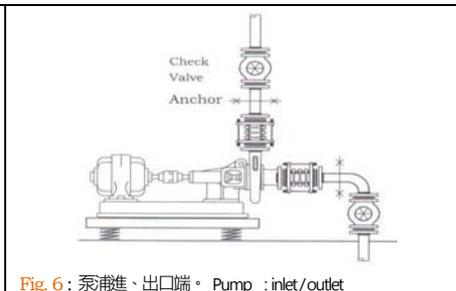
泵浦進、出口端。 Pump : inlet/outlet
